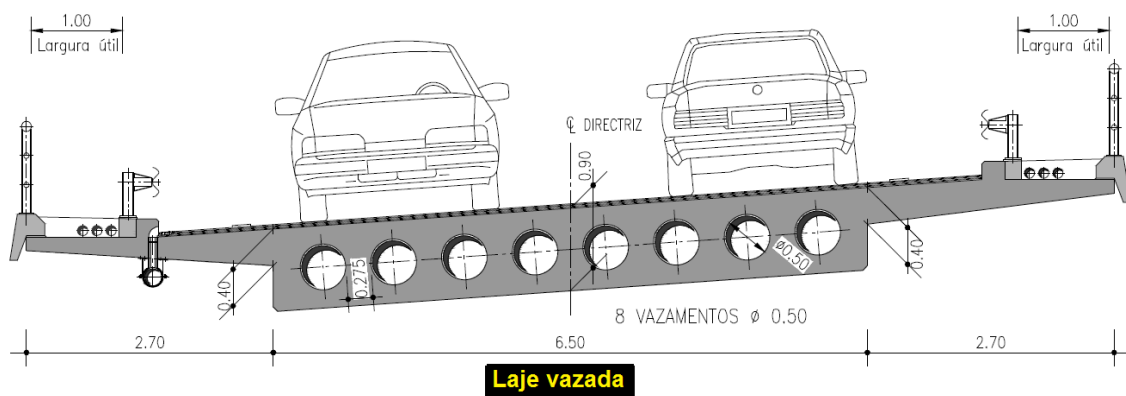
Secção do tabuleiro de uma ponte em laje vazada (Pedro, 2007).
